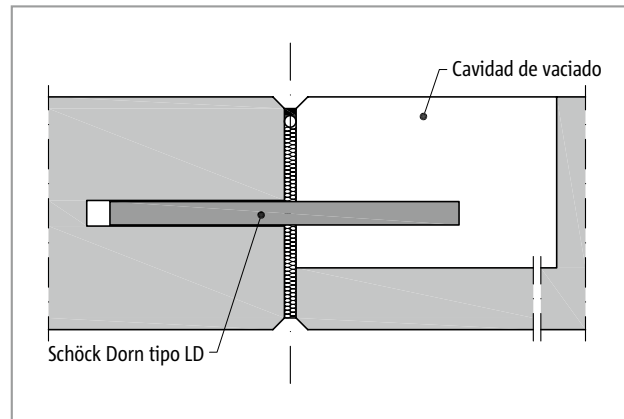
Schöck Dorn: Formación de juntas de expansión en balcón prefabricado
